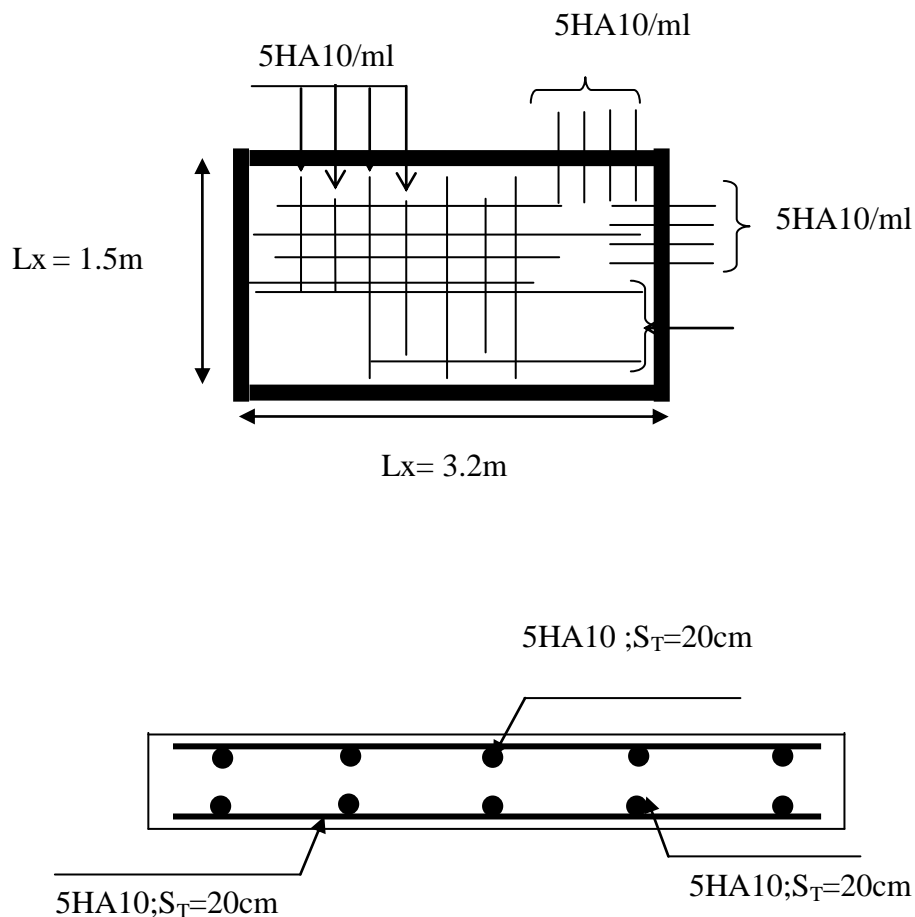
Schéma de ferrailage de la dalle sur 4 appuis
